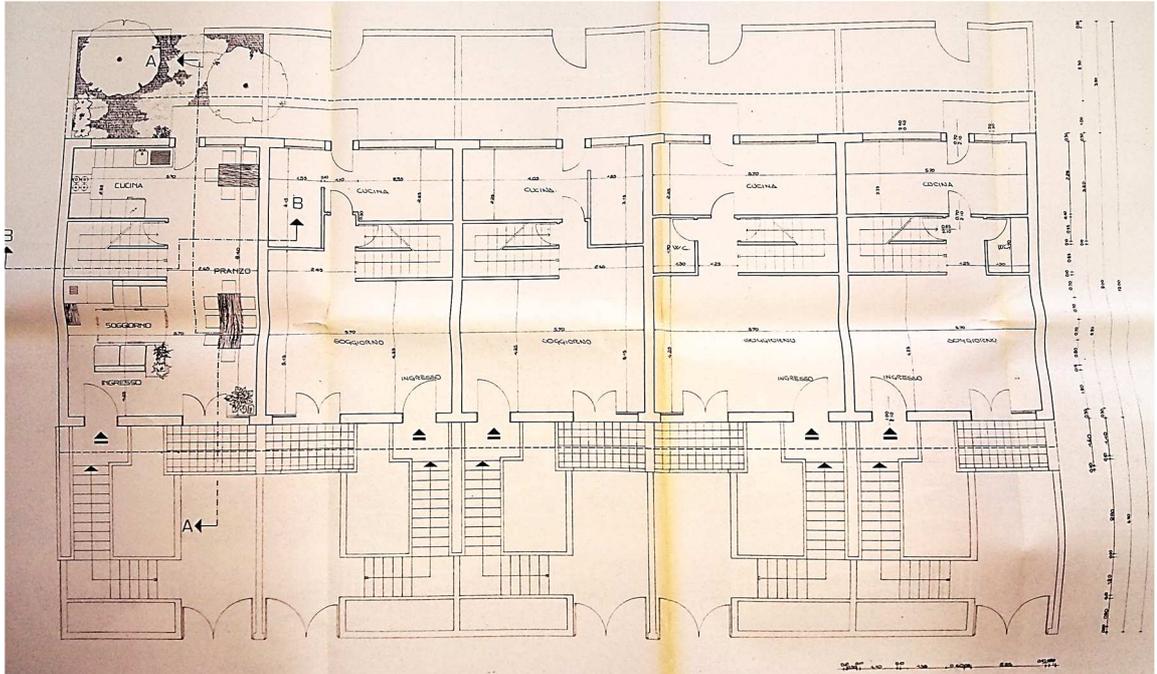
Pianta piano rialzato dell'edificio campione.
